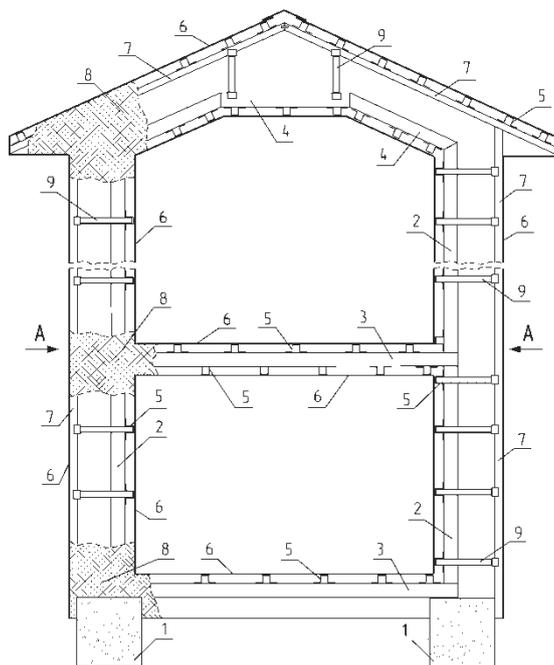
Поперечный разрез здания: 1 – фундамент; 2 – колонна внутреннего каркаса; 3 – ригель внутреннего каркаса; 4 – балка перекрытия; 5 – гнутый профиль; 6 – лист опалубки; 7 – внешний каркас; 8 – лёгкий бетон; 9 – временный фиксатор
